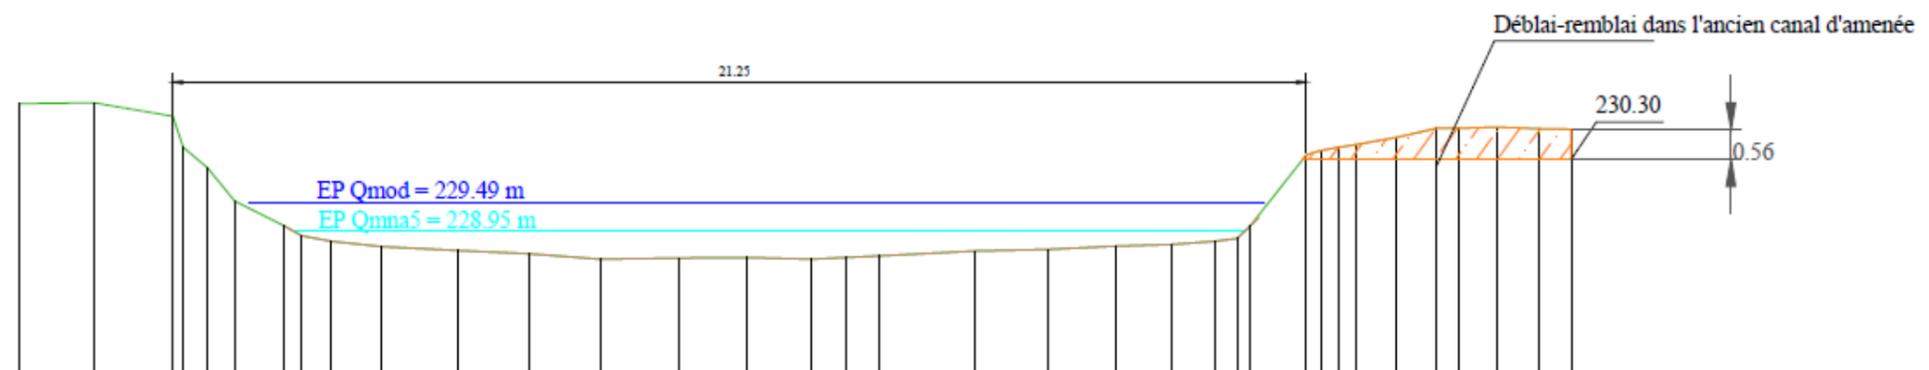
Opération 6 - Extrait du profil en travers n°7 - coupe AVP (ARTELIA, mai 2021)
